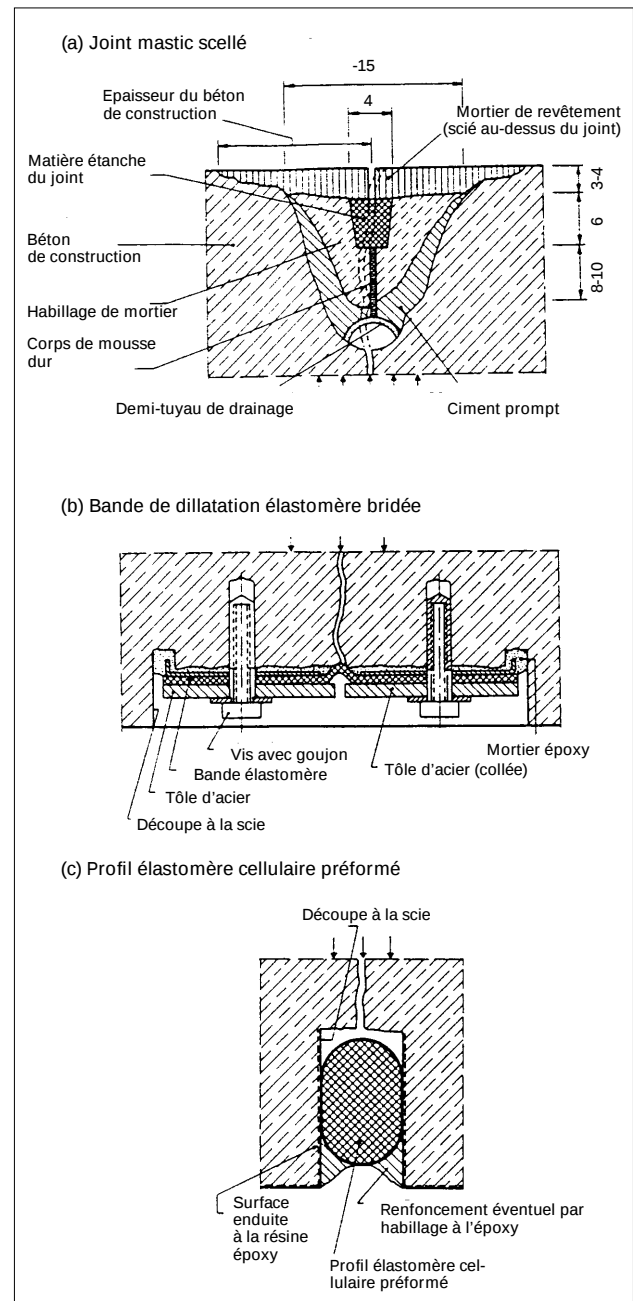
Trois possibilités pour assurer l'étanchéité d'une fissure de largeur variable apparue après coup, selon [4.49]
